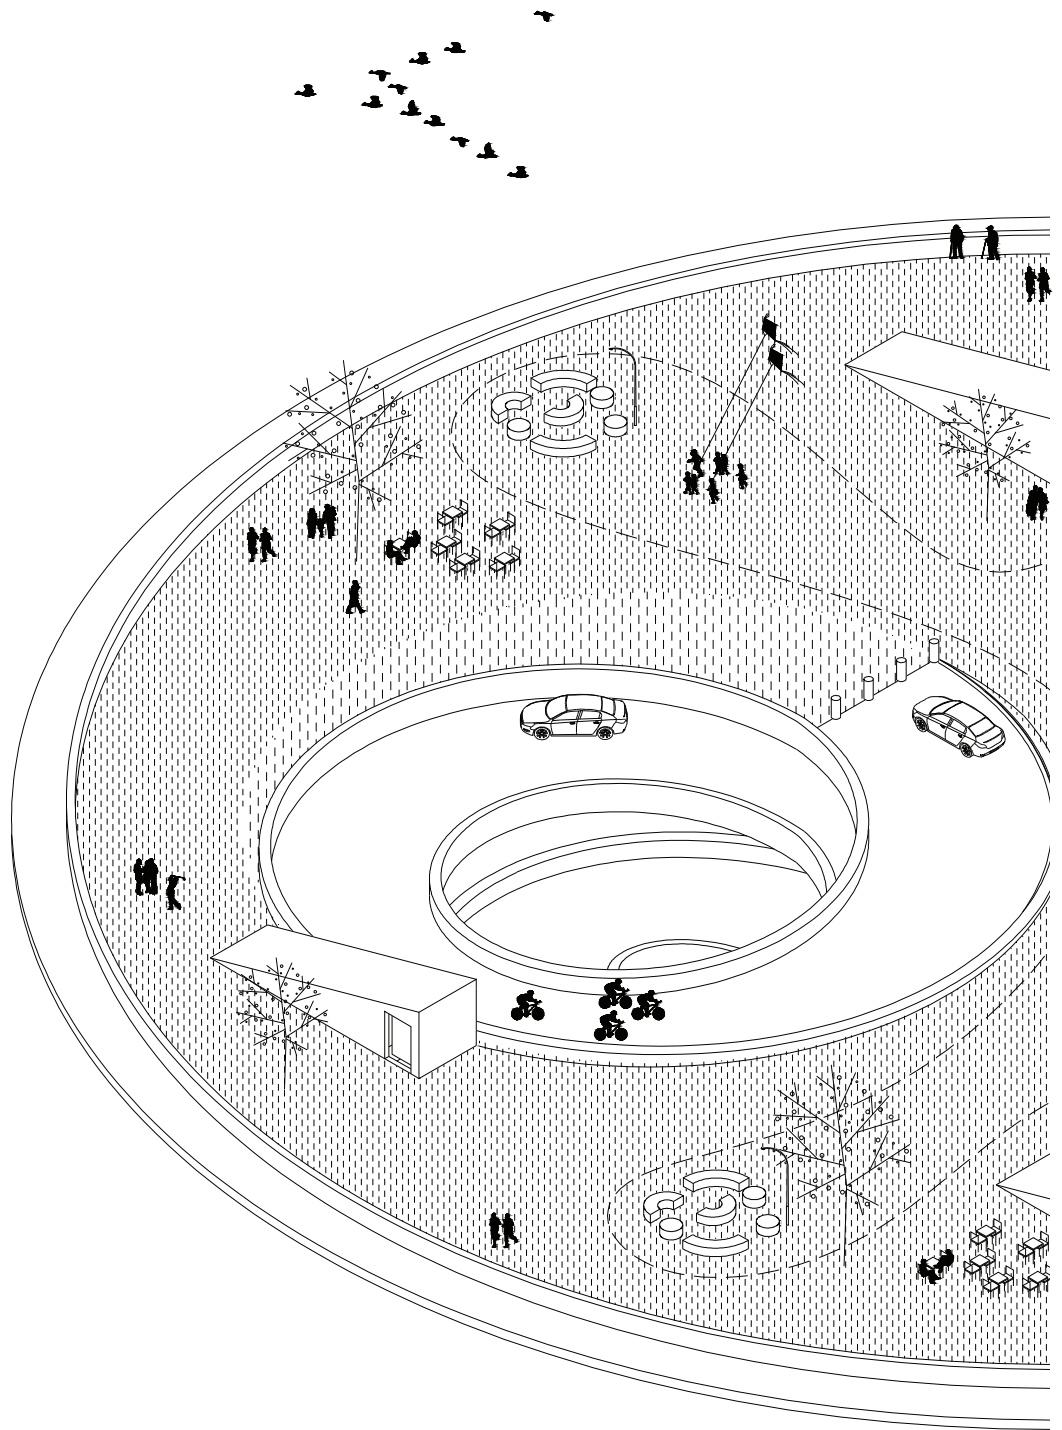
Grundrissaxonometrie . Öffentlicher Raum . 1:400
